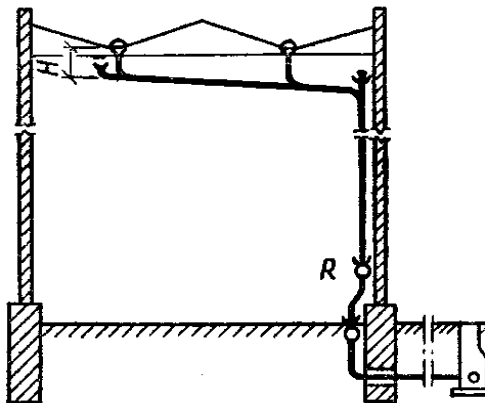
Схема внутреннего водостока с двумя воронками, объединенными подвесным трубопроводом с закрытым выпуском
